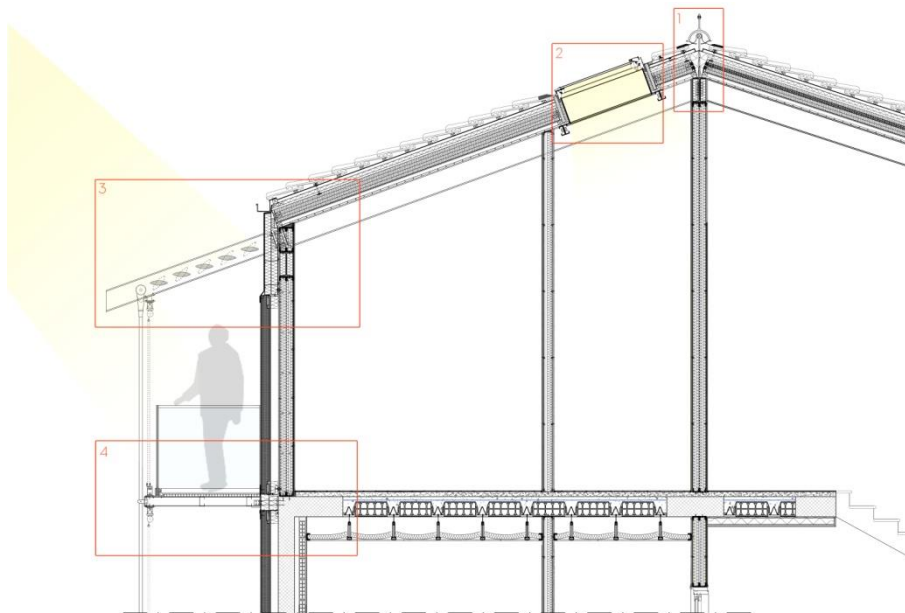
, Dettaglio sezione piano quarto. Fonte autore tesi
